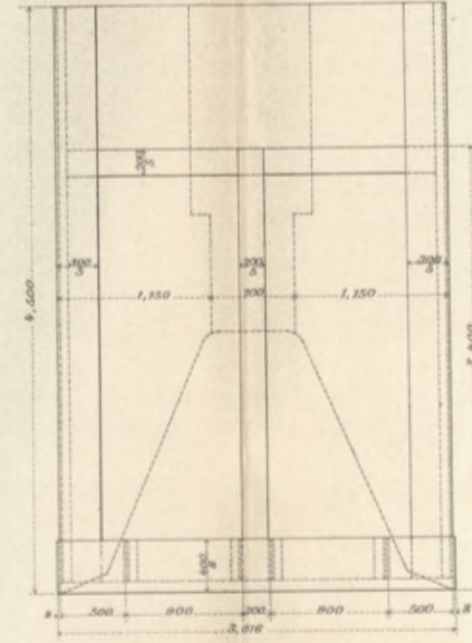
Halber Grundriss. M. 1:60.
